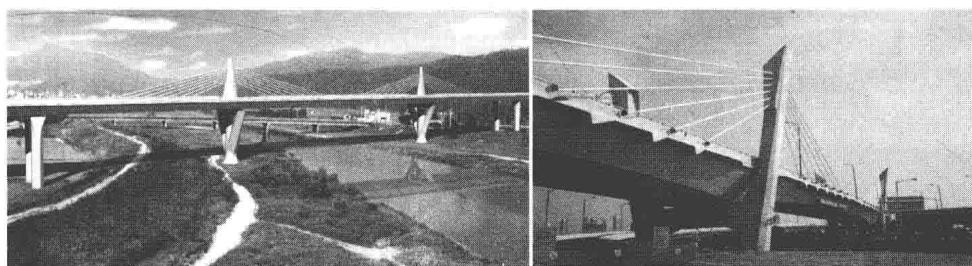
Keong-An Bridge (左) 和 Approach to inchon Bridge (右)
